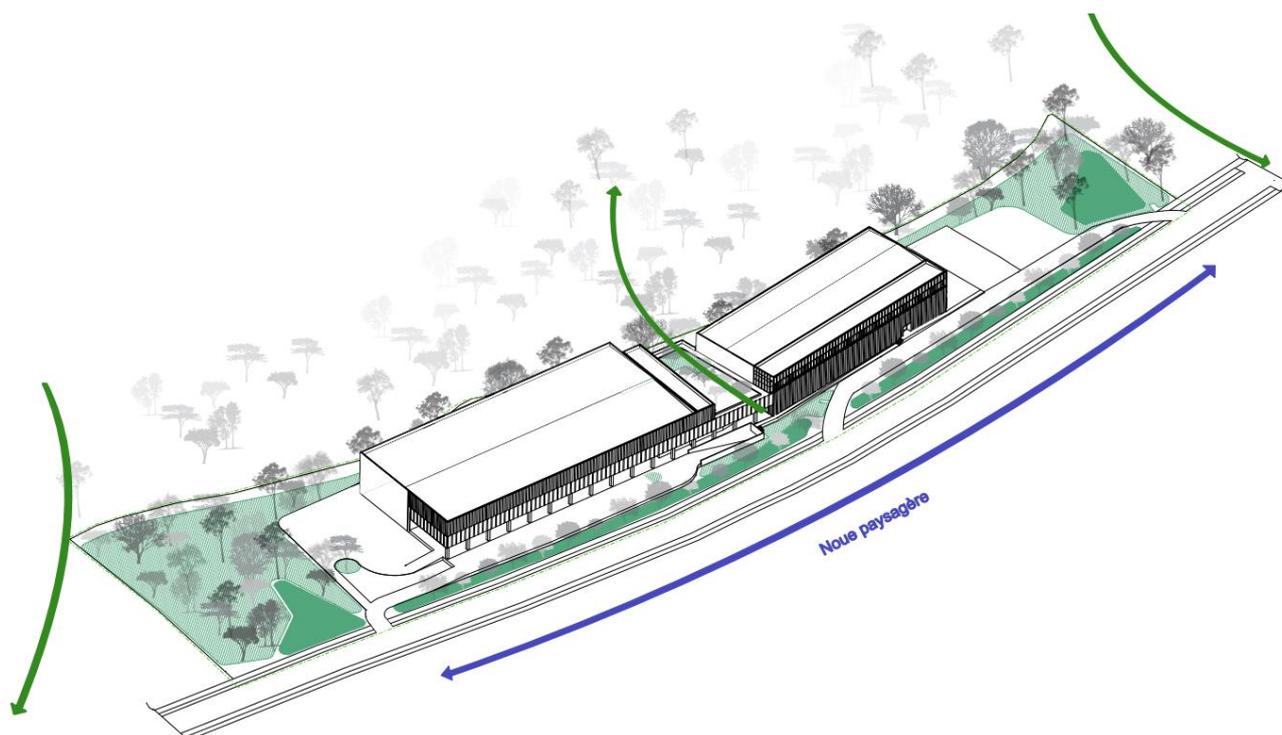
Plan général des espaces verts au droit des futurs aménagements (source : Jean-Paul-GOMIS Architecture)
